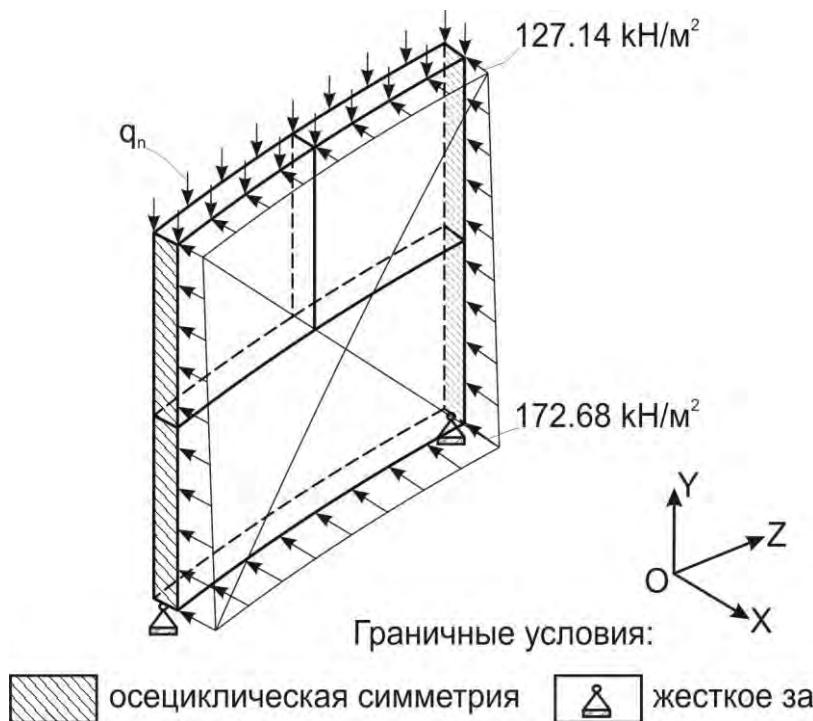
Принципиальная расчетная схема стенки резервуара
